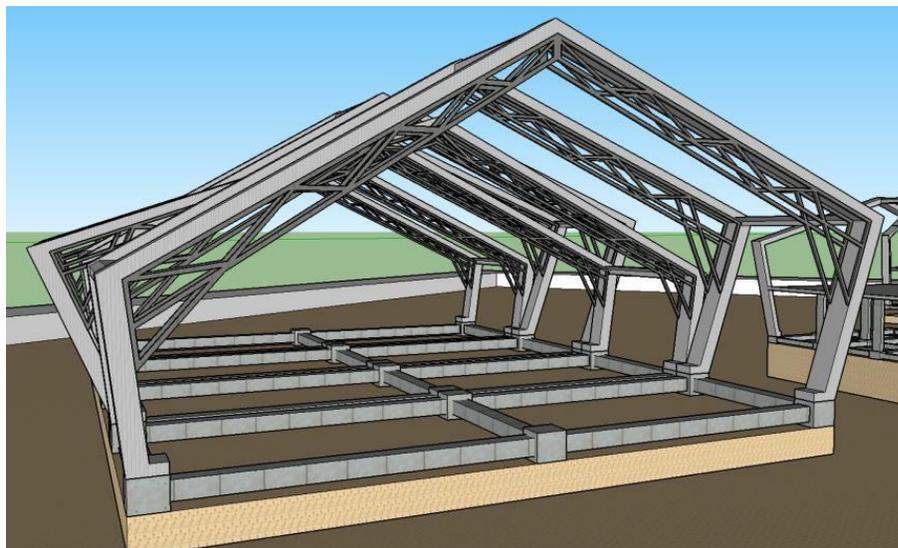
Detalle Constructivo Estructura metálica y cimentación Bloque A
